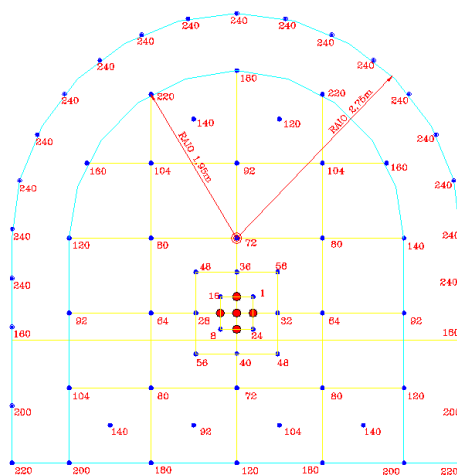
Plano de detonação para seções de $(5,5 \times 5,5)$ m² contemplando a sequência de detonação de cada furo em milissegundos.
